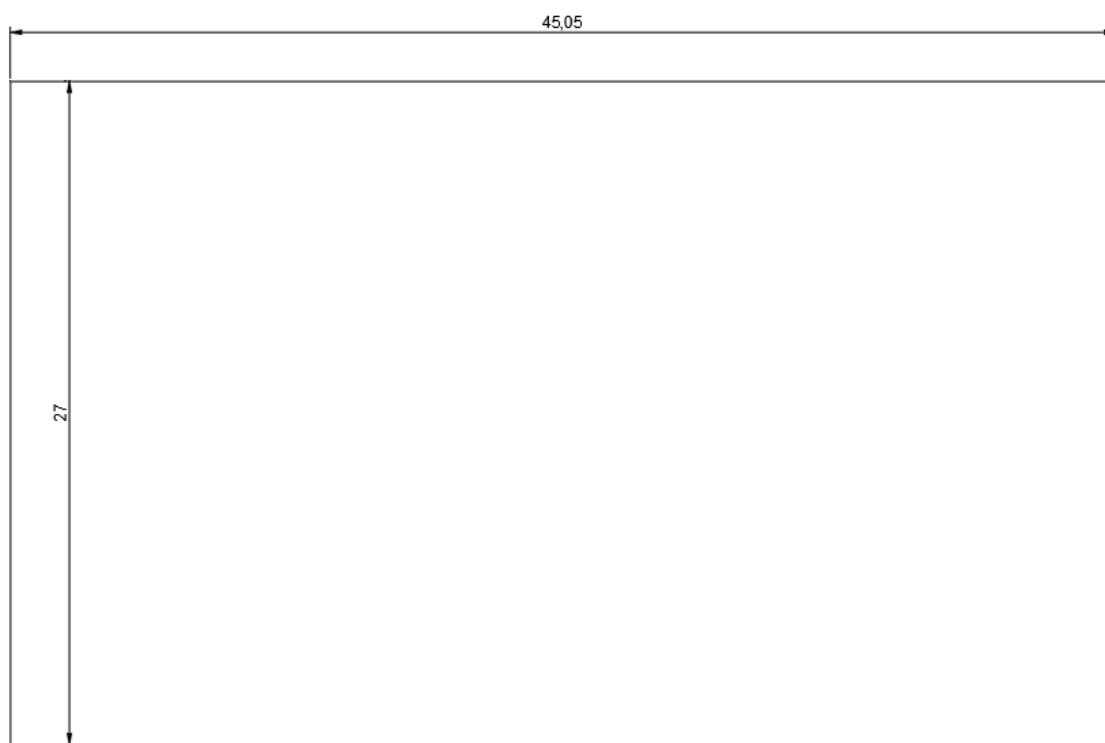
Dimensiones de la cubierta en metros (vista planta). [Elaboración propia]
